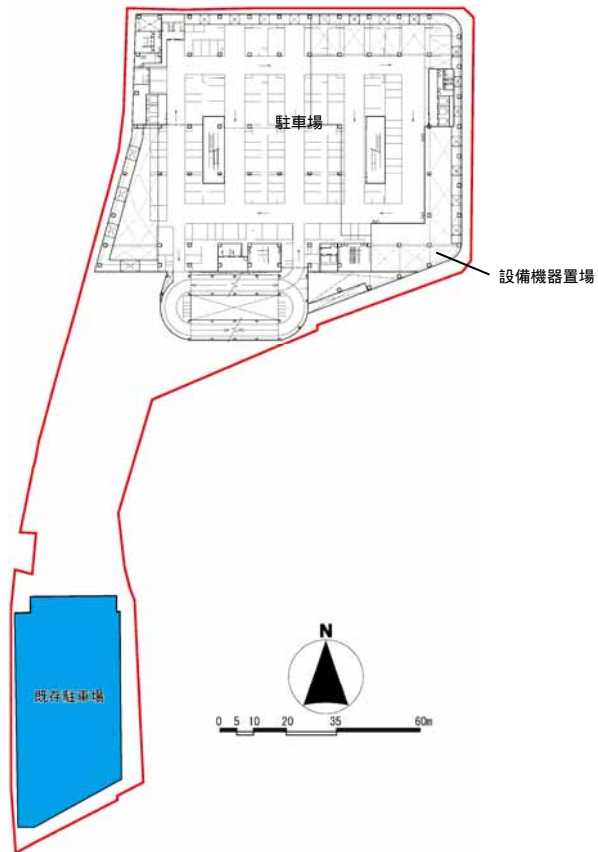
(11) 各階平面図 (9 F) (変更前 : 評価書)
